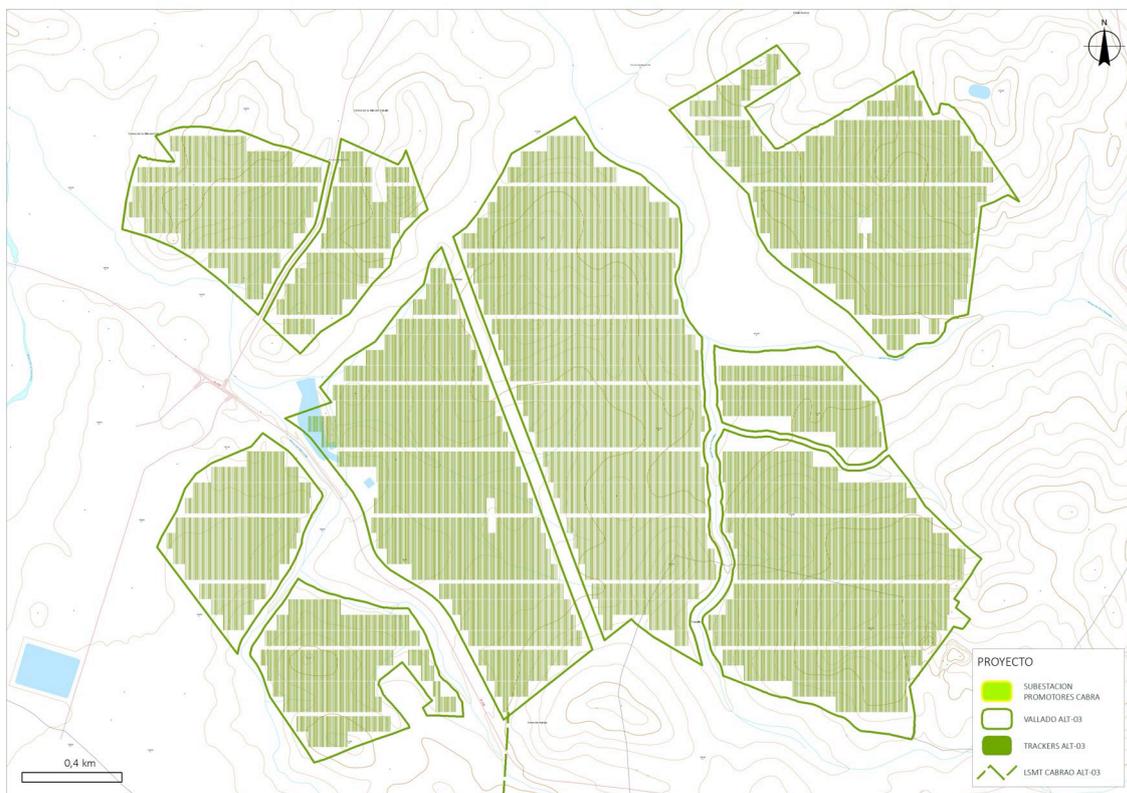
Plano de Detalle del Proyecto (Alternativa-03).
